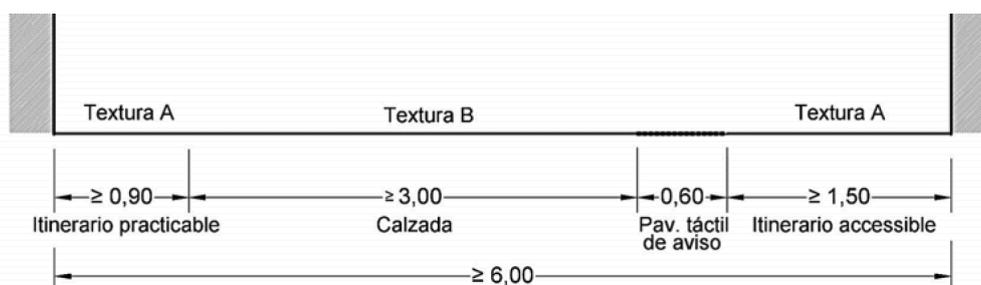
1. Ejemplos de alternativas para una vía de uso mixto de ancho 6,00 m o superior con itinerario practicable a un lado
